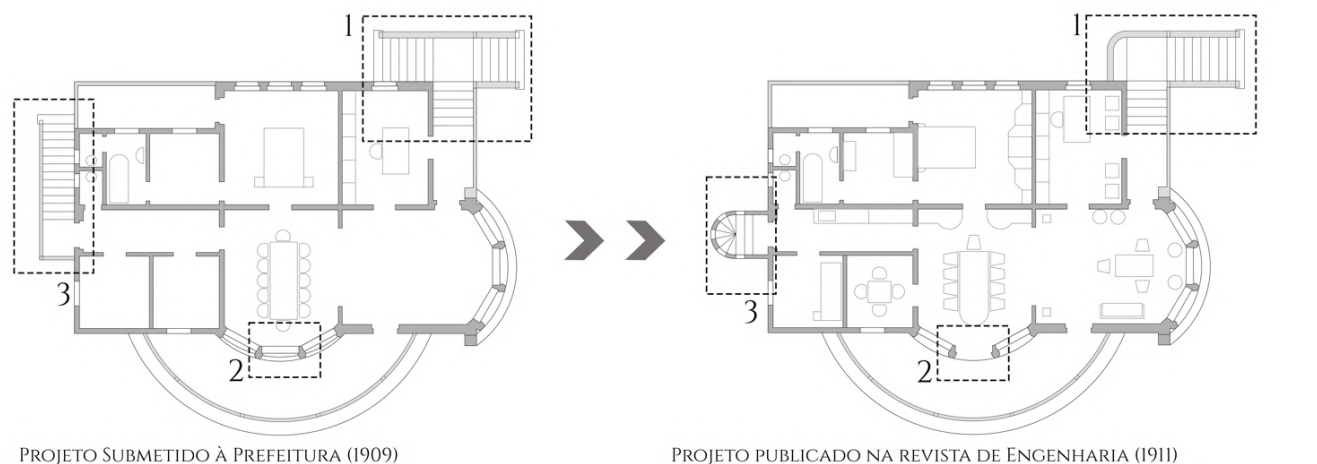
Modificações da planta do pavimento superior da Villa Mário Rodrigues (1909).
